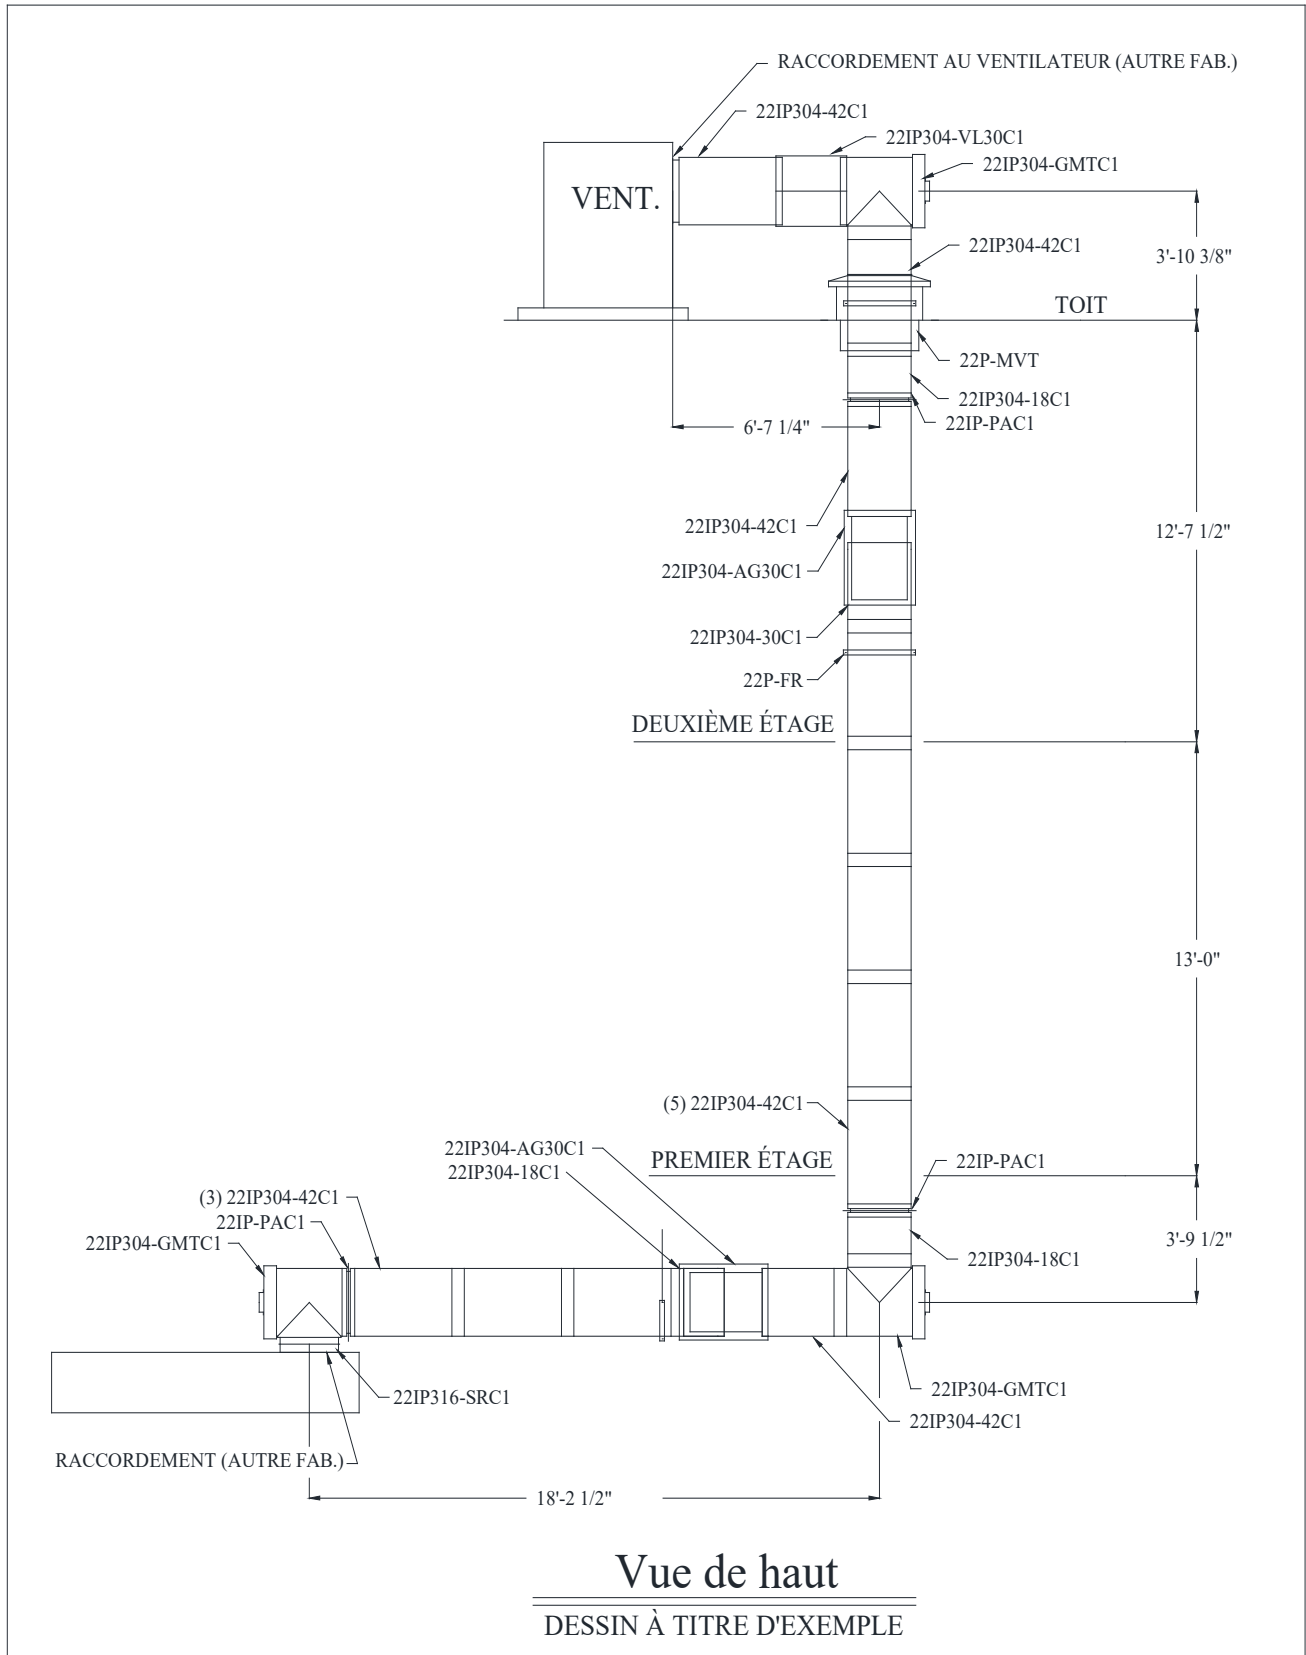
Exemple de dessin (installation de conduit de graisse)
